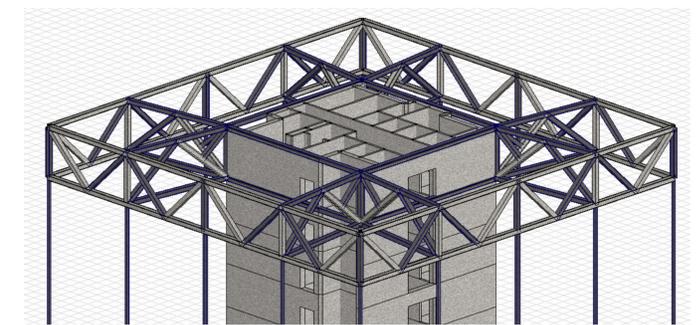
3D Modell Fachwerk Abfanggeschoss mit Betonkern (ohne Decken)
